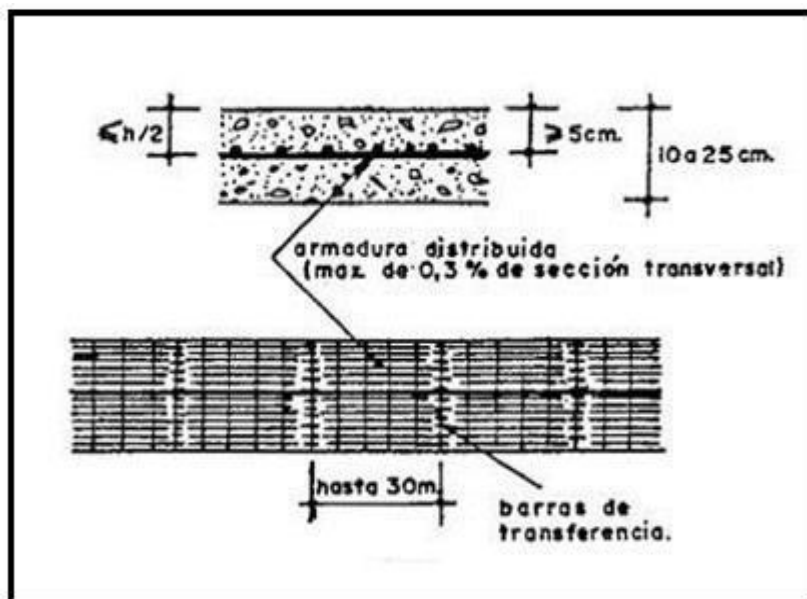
Pavimentos de concreto con refuerzo de acero no estructural
